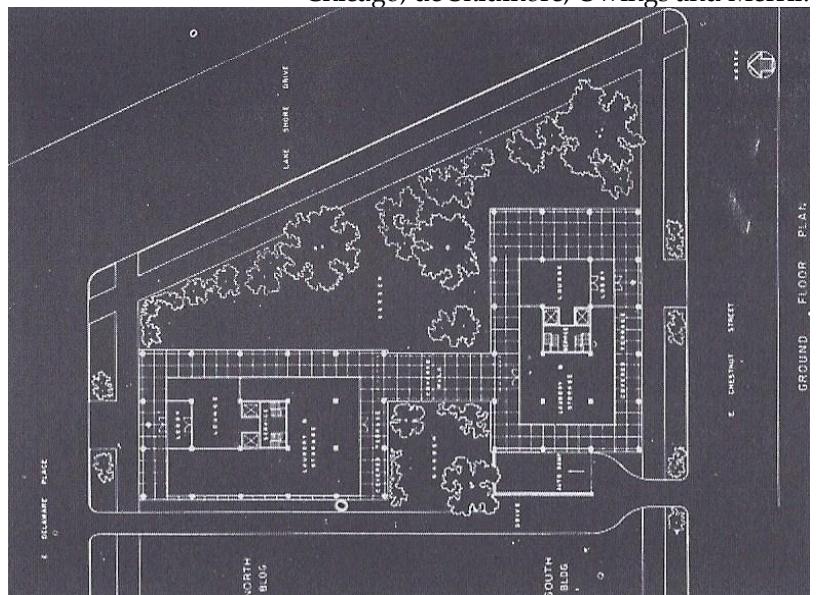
Planta baixa do Lake Shore Drive Apartments, 1948-51, Chicago, de Skidmore, Owings and Merrill.
